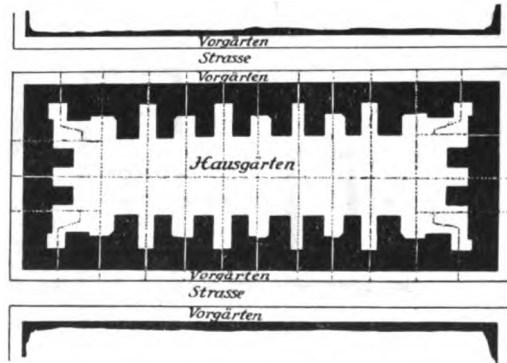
Geschlossene Bauweise mit Lichtgassen. Nach Nußbaum.
